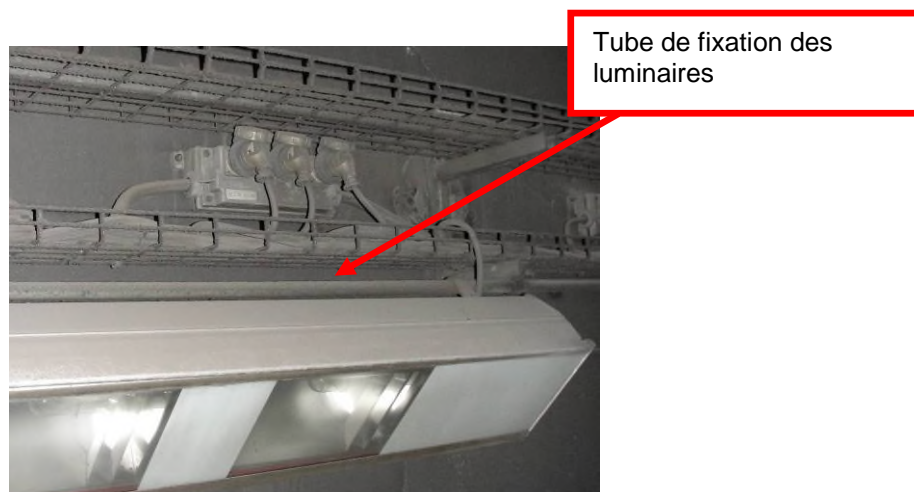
Installations d'éclairage et raccordement des luminaires normaux
